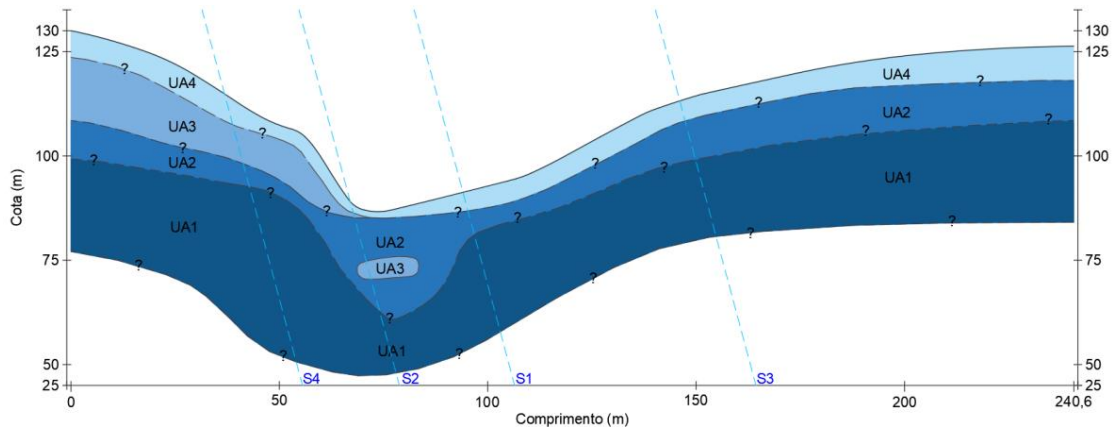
Perfil A-A' para o ensaio de Lugeon dos terrenos de fundação da barragem.
